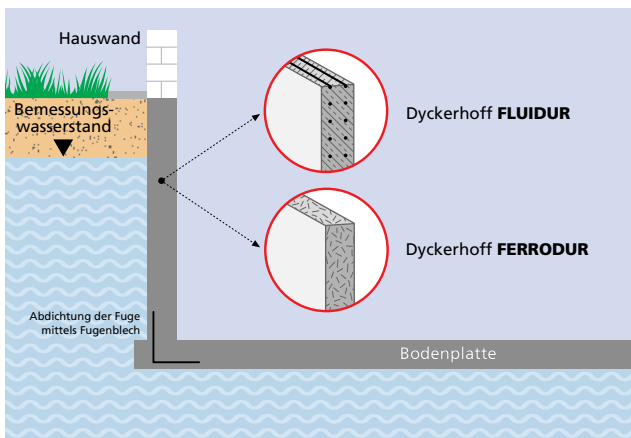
Wasserundurchlässige Bauwerke (Weiße Wannen) aus Beton ohne zusätzliche Abdichtung
